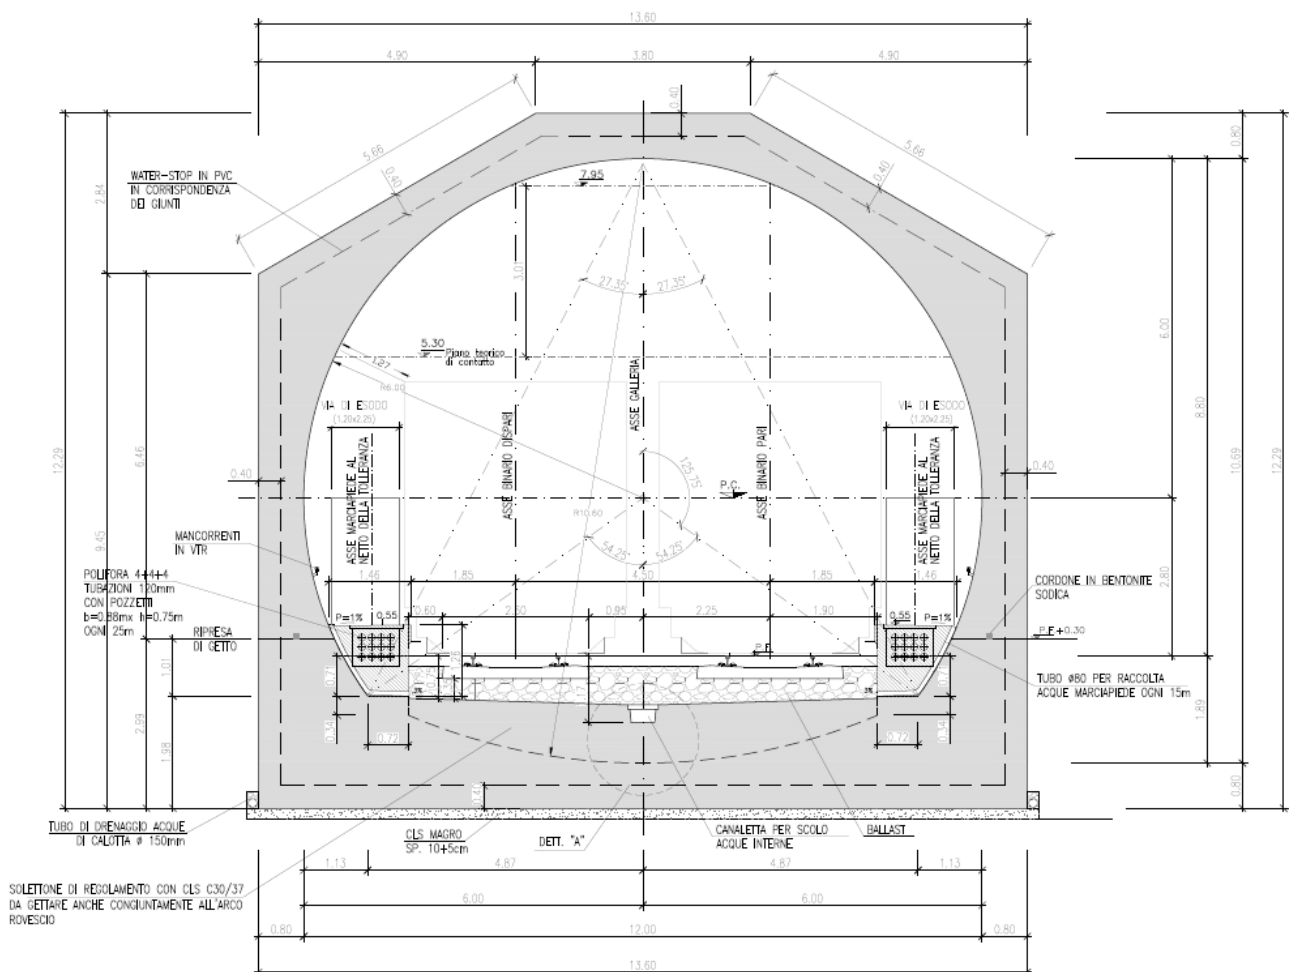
Sezione trasversale della galleria artificiale (Sezione tipo P1).
